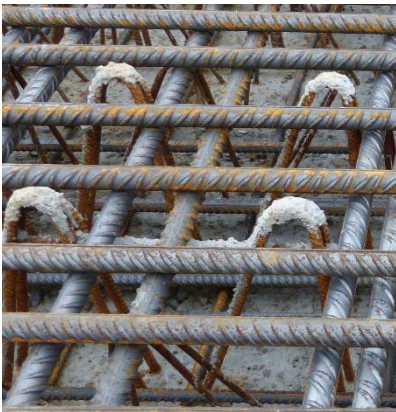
Einbau FILIGRAN®-Durchstanzbewehrung FDB
